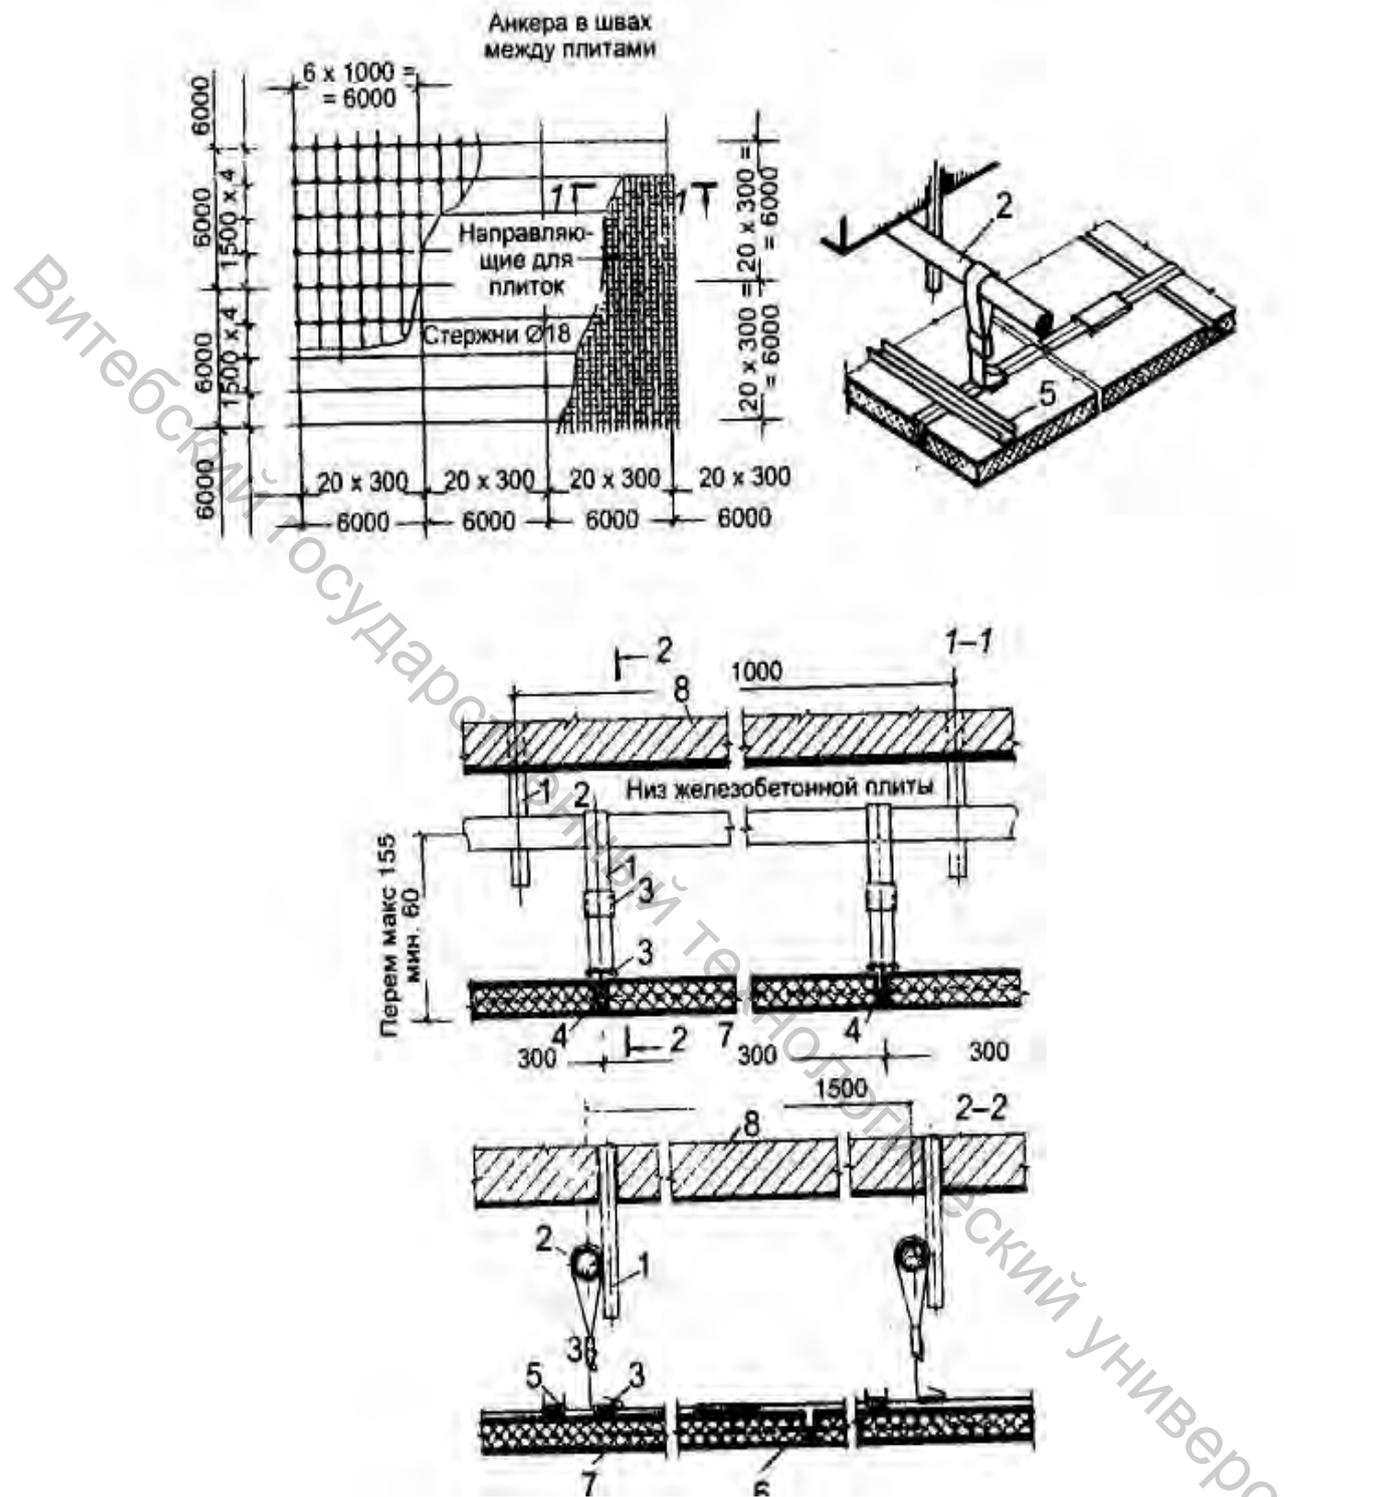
Подвесной потолок с опиранием плит по двум сторонам:
